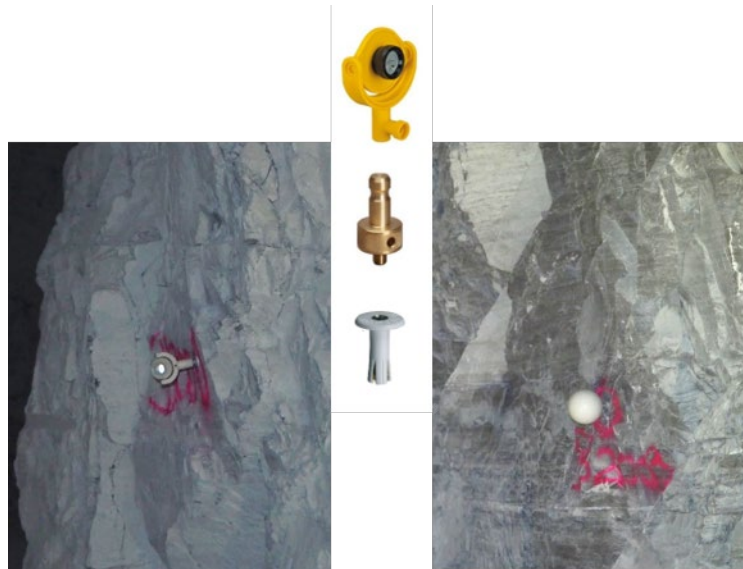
Anbringen von Gewindeaufnahmen (Dübelbolzen) für Steckzapfen
